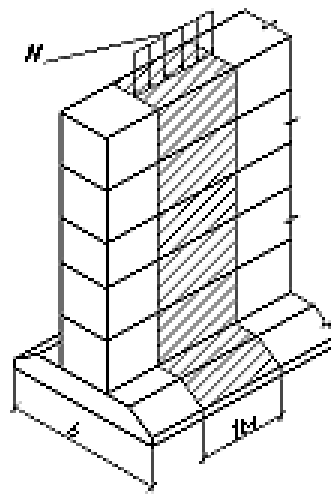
Схема збору навантажень на 1 м довжини фундаменту
